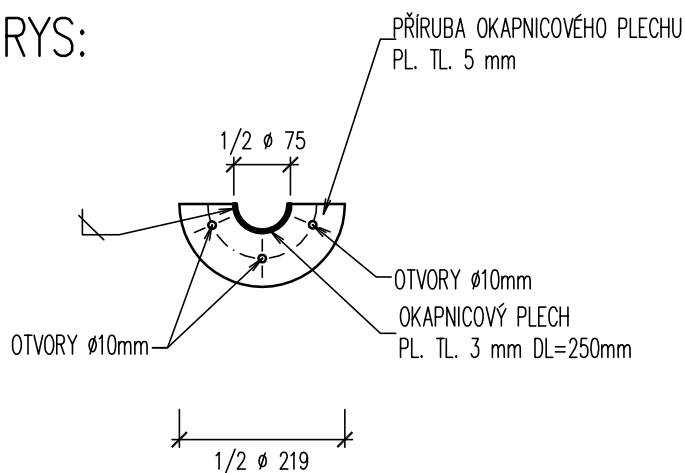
# DETAIL OKAPOVÉHO PLECHU NA OKRAJI ÚLOŽNÉHO PRAHU – VÝPIS MATERIÁLU 1 : 10
